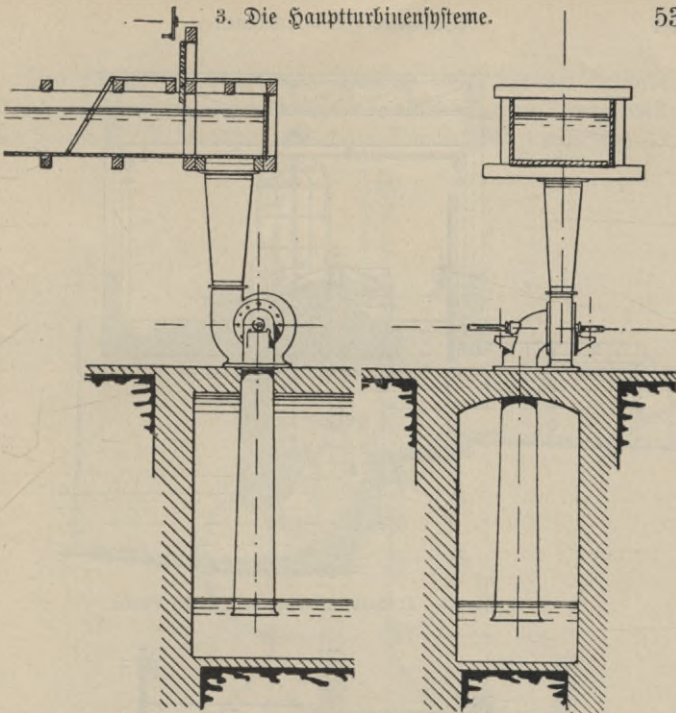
Einbau einer Spiralturbine mit hölzernem Gerinne.
